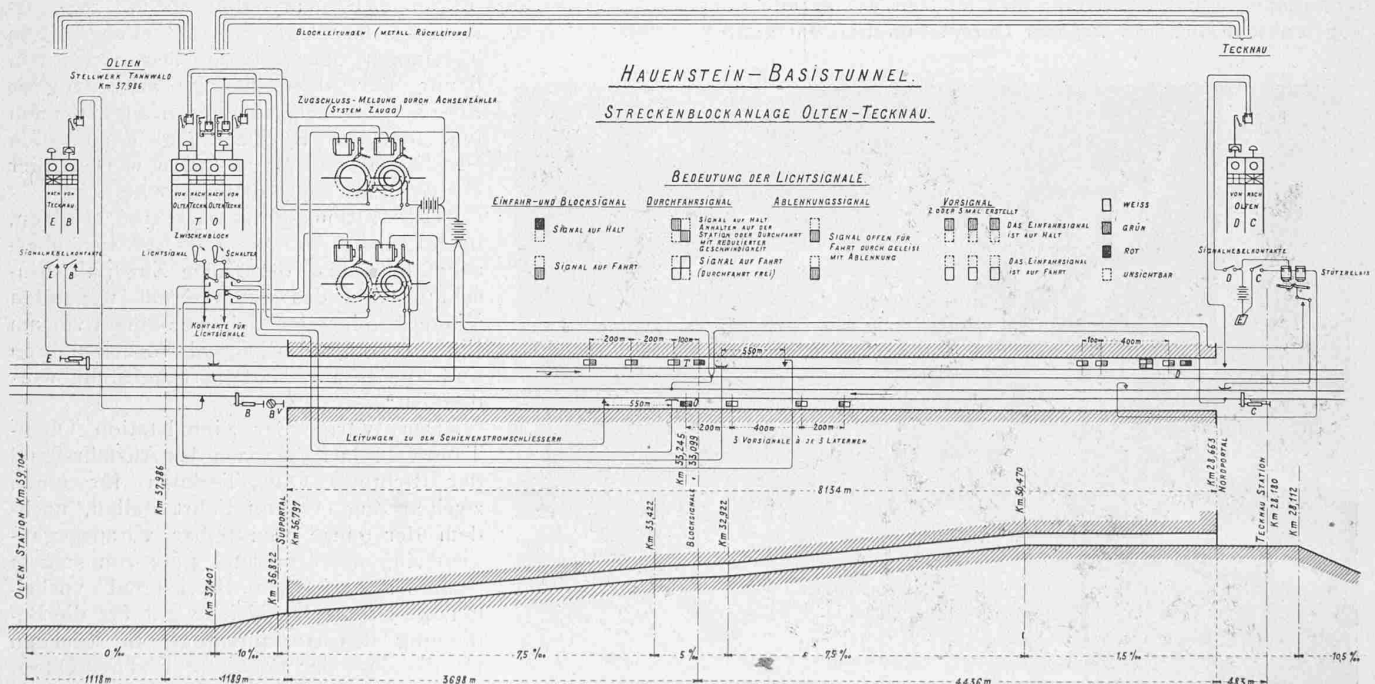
Längenprofil des Hauenstein-Basistunnel mit schematischer Darstellung der Streckenblockanlage Olten-Tecknau.
